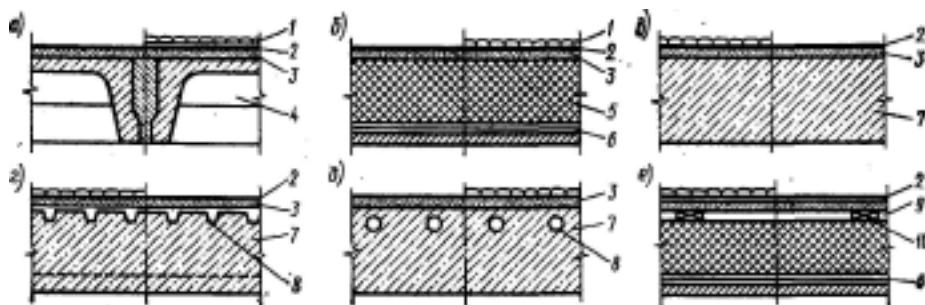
Основные типы покрытий с железобетонными плитами и рулонными кровлями:
